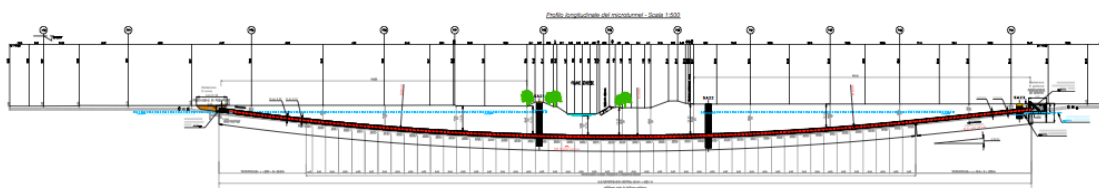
Profilo di progetto del microtunnel del cantiere 1.
